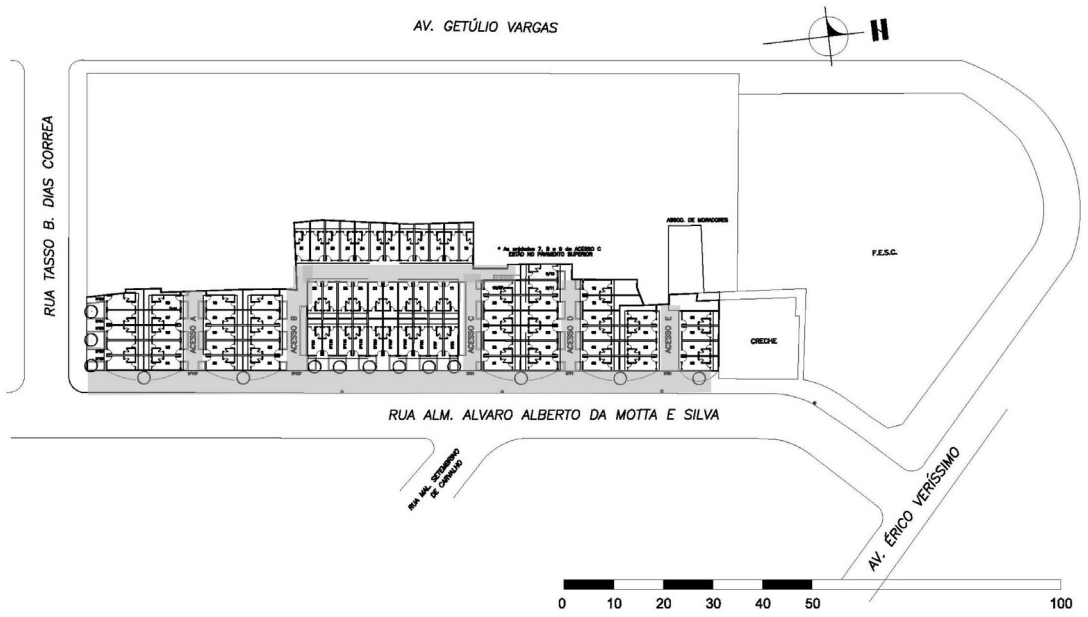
Planta baixa da vila Lupicínio Rodrigues
